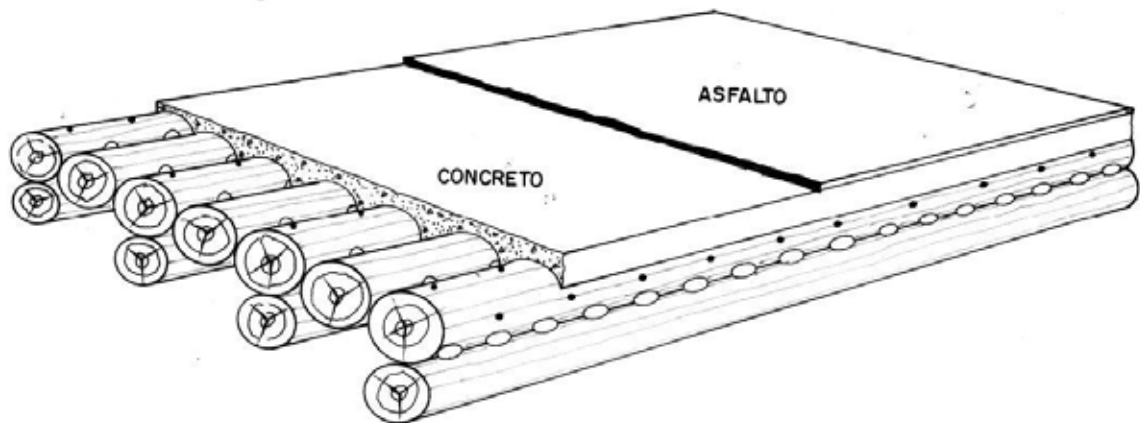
Proposta para construção da ponte de postes de madeira solidarizada por uma camada de concreto e asfalto. Fonte: Matthiesen (1987)
